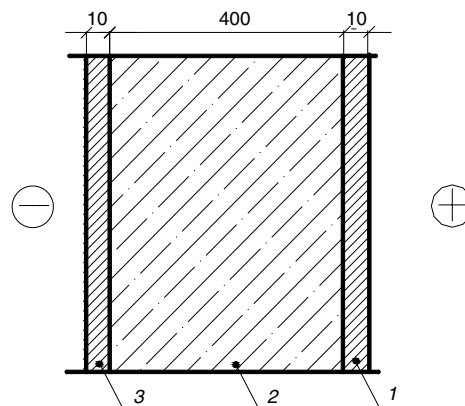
Сечение наружной стены: 1, 3 – цементно-песчаный раствор; 2 – кладка из крупногабаритных керамзитобетонных камней
